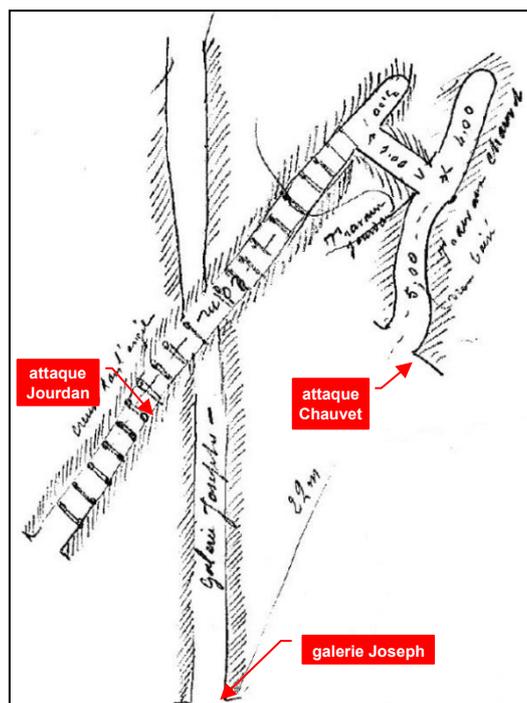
Mine Joseph, travaux Jourdan et Chauvet, extrait (arch. DREAL 6.1.4)
